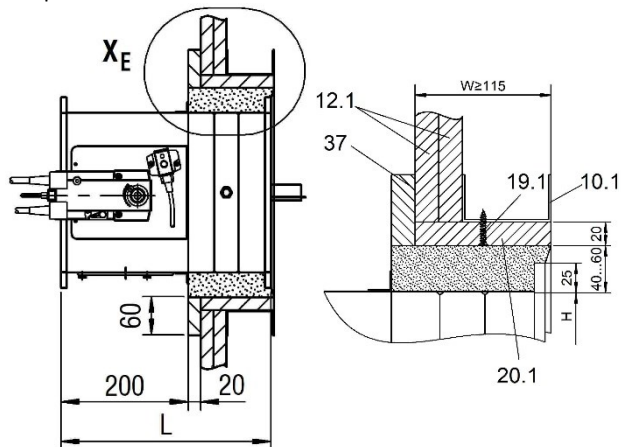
Parement du mur et doublage (cloison pour gaine)
